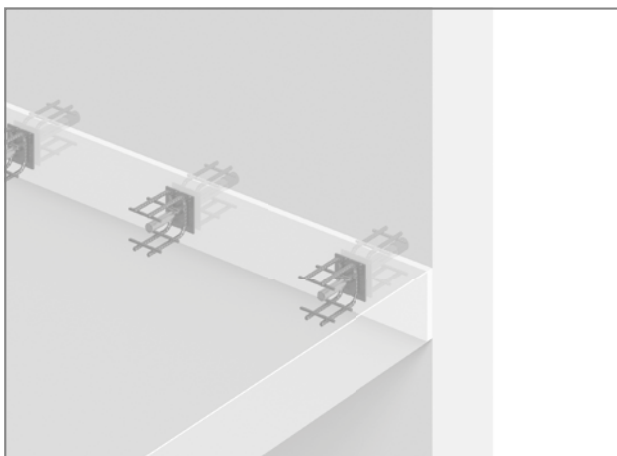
Schöck Dorn type SLD : liaison dalle-mur
